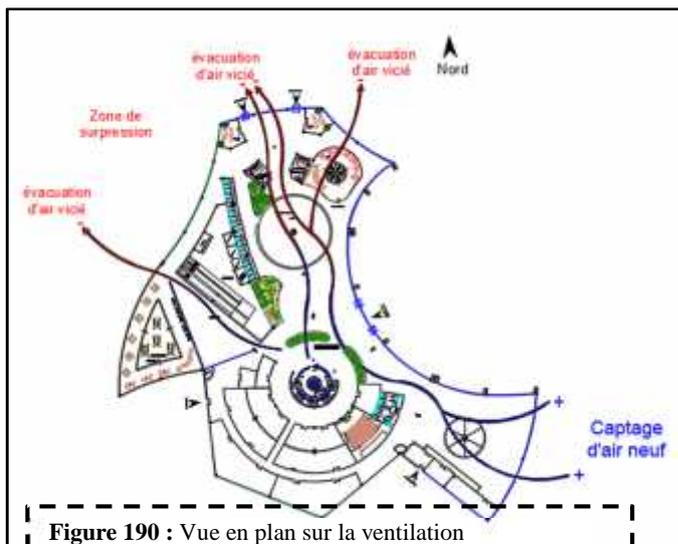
Vue en plan sur la ventilation Transversale en club des yachts.
